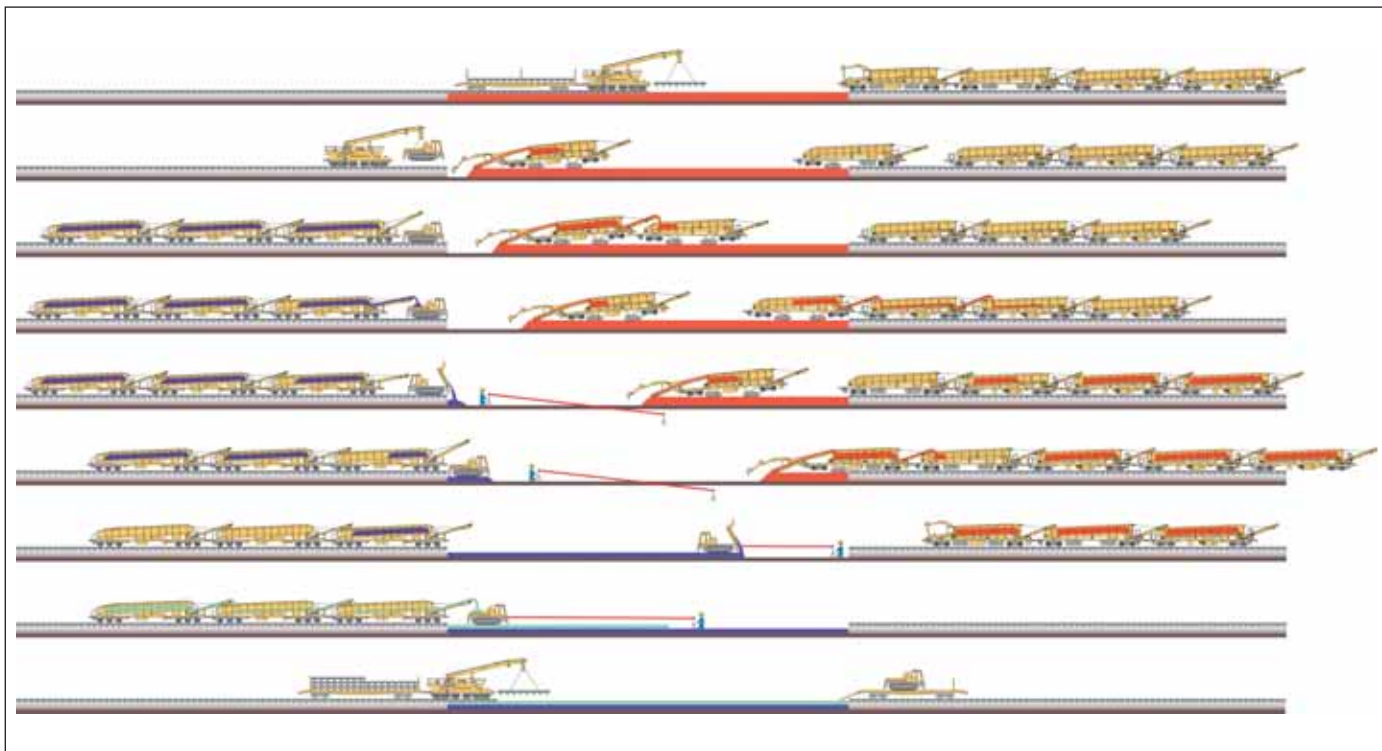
Systemdarstellung – Gleisloser Schottertausch mit Planumsverbesserung
